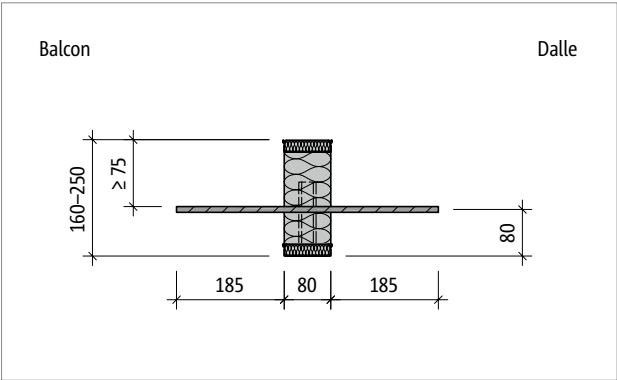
Schöck Isokorb® T Type H-NN1 : Coupe du produit
